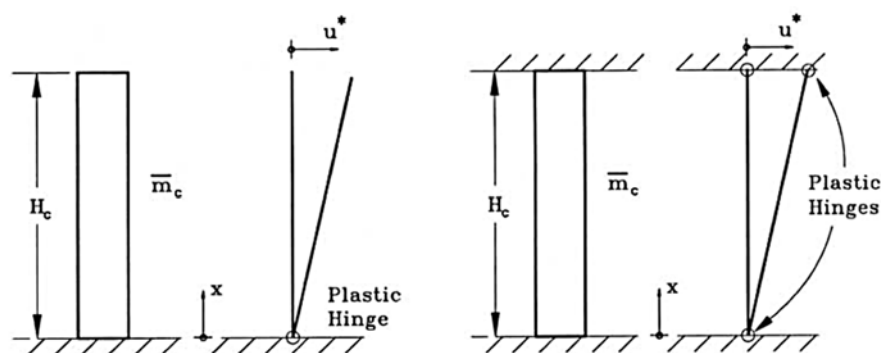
Pila e përbërë nga një kollonë ([1])
